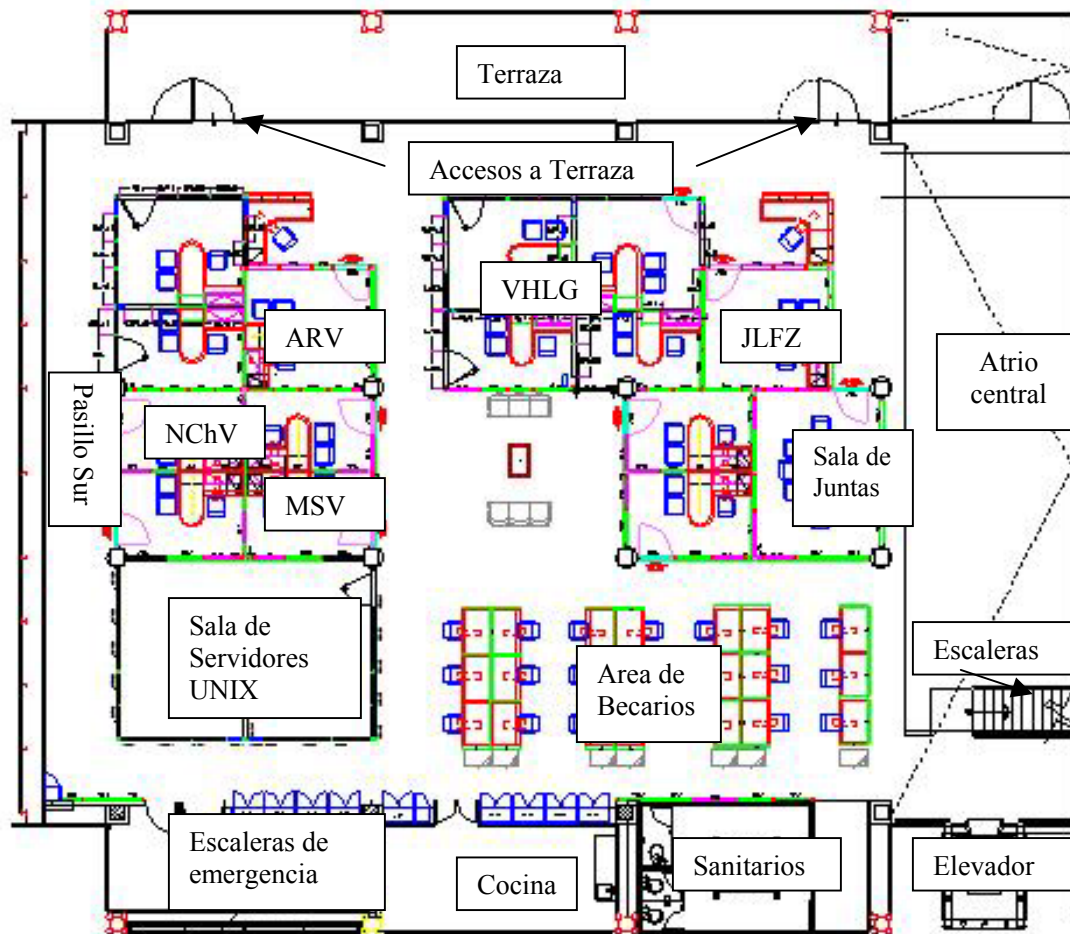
Vista de planta del ala sur del primer piso de la torre de ingeniería.
